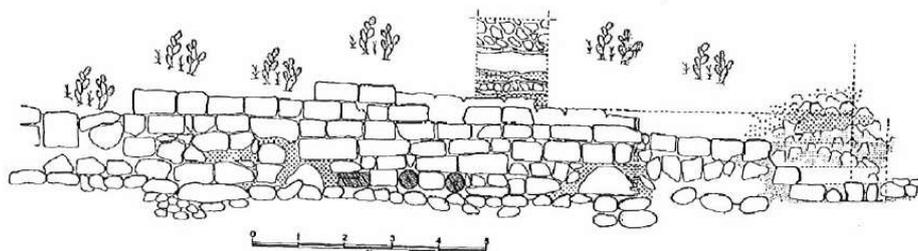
Levantamiento planimétrico de la muralla del lado sur en 1980. (GONZÁLEZ BLANCO y MOLINA GÓMEZ, 2002-2004: 30).
